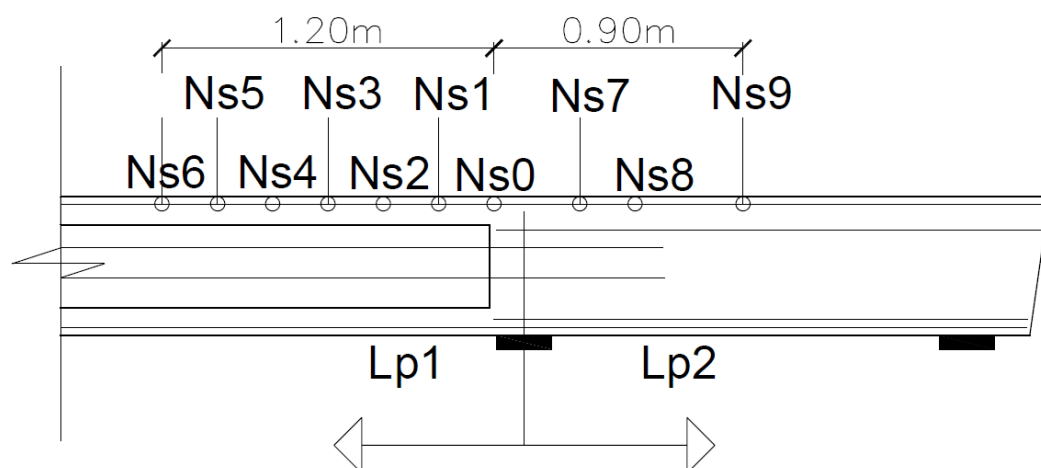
Esquema de longitud plástica para las vigas ensayadas
